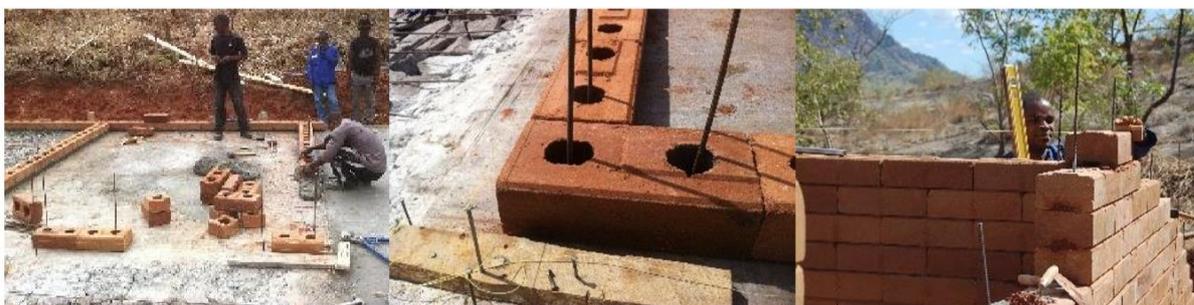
Processo de construção em BTC, levantamento das paredes, projeto startup da Dwell Earth em Moçambique 2013. (Da Silva, 2015:28)
